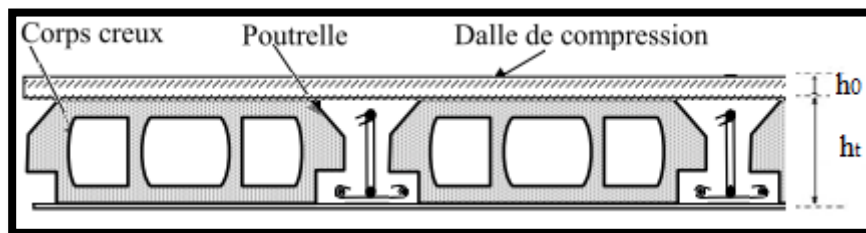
Coupe transversale d'un plancher à corps creux.
